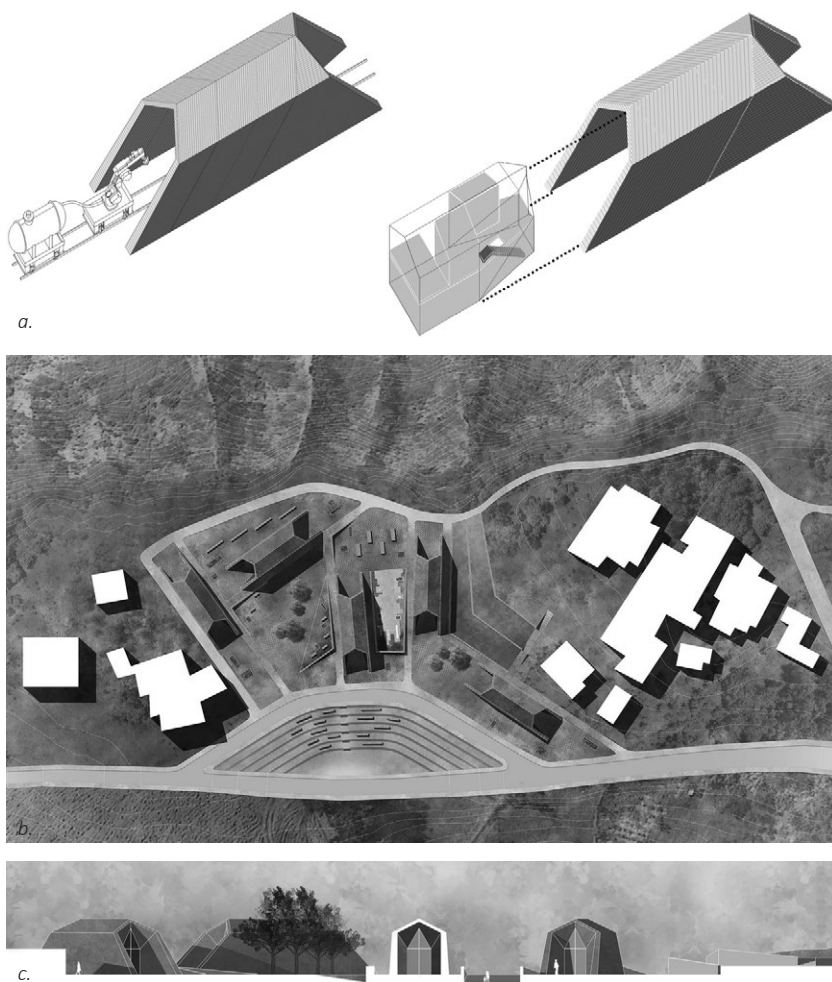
a. Assonometria del progetto in fase di stampa e con inserimento dell'allestimento funzionale; b. Planimetria generale di progetto; c. Sezione territoriale di progetto.
